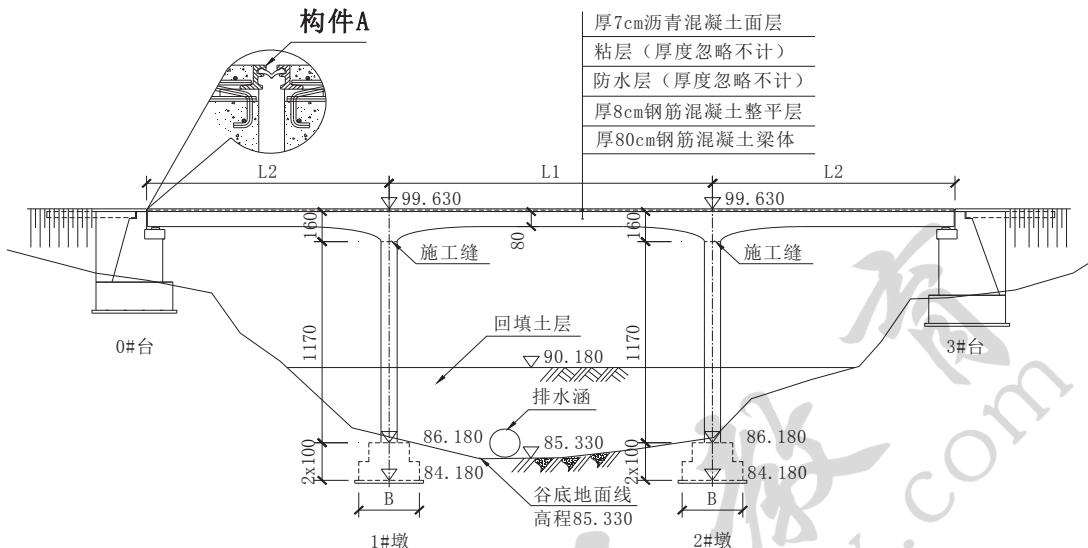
桥梁立面布置示意图（高程单位：m；尺寸单位：cm）
